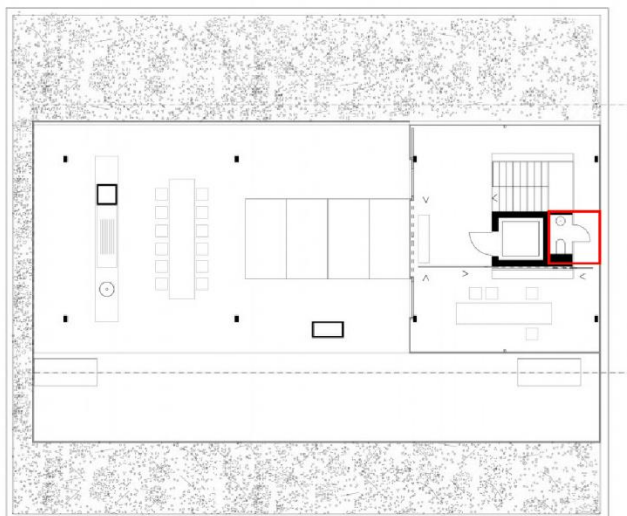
Úpravy svislých konstrukcí v 1NP
